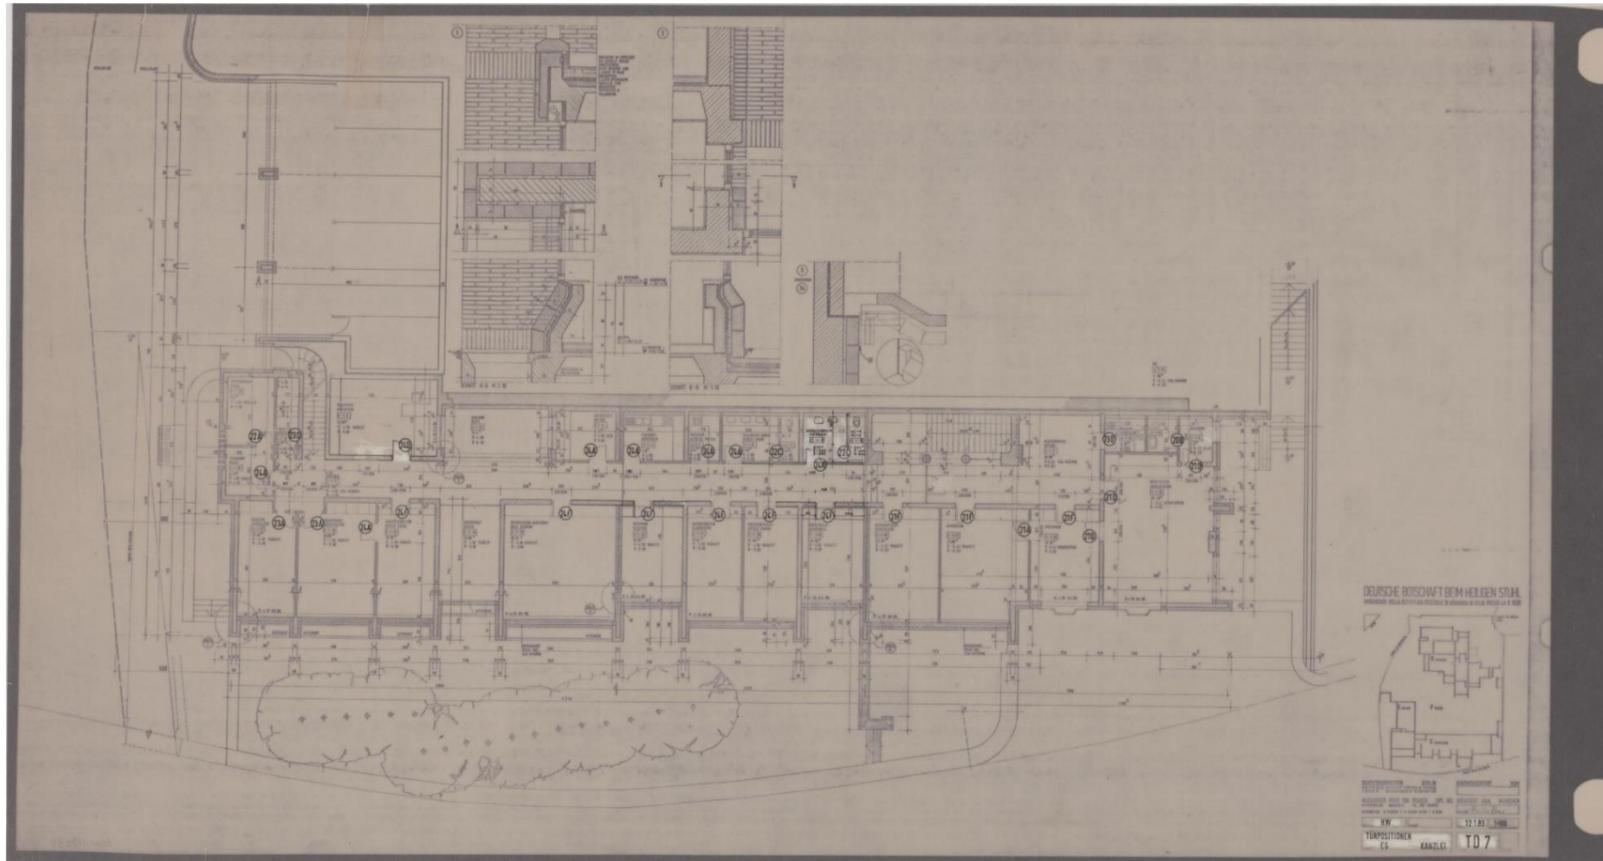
Kanzlei 1983 (Grundriss EG)
